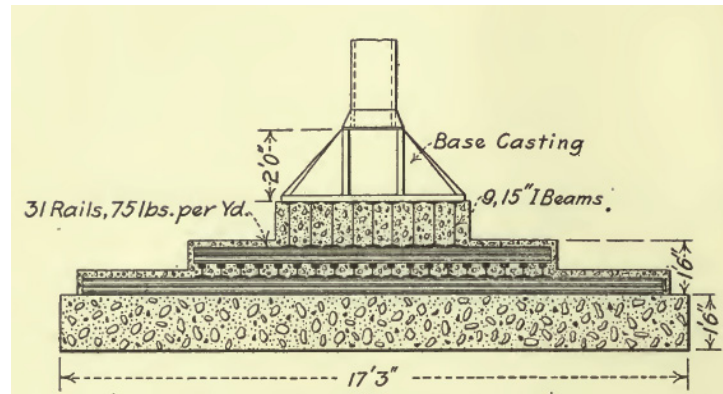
Cimentación mediante emparrillado de vigas metálicas. Buel [3].
